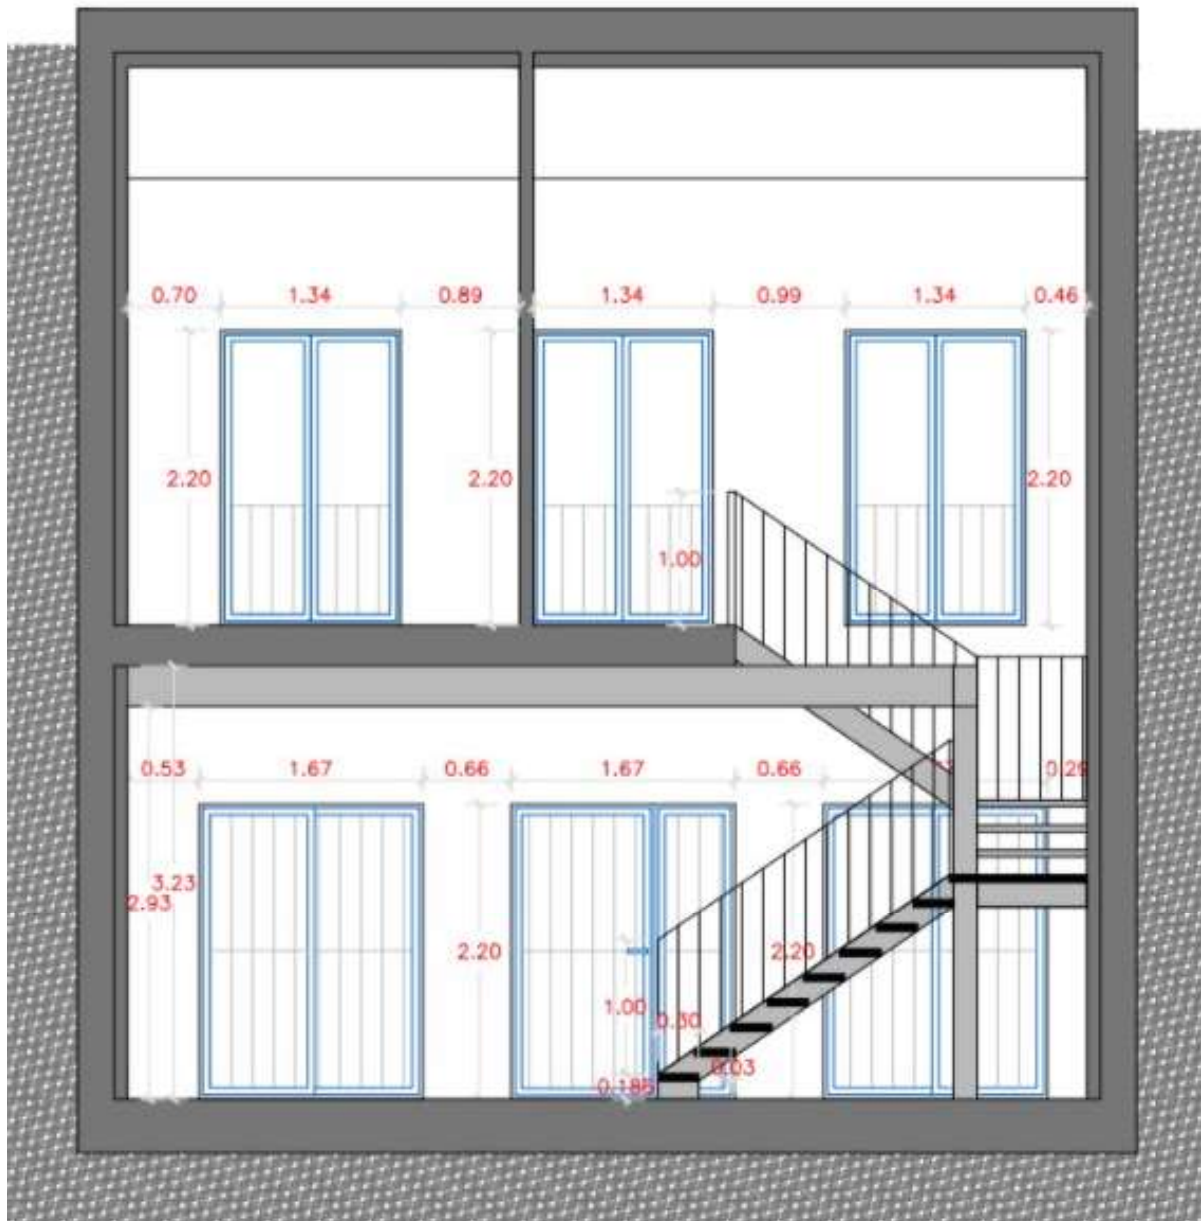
Sección II vivienda proyectada (proyecto básico)
